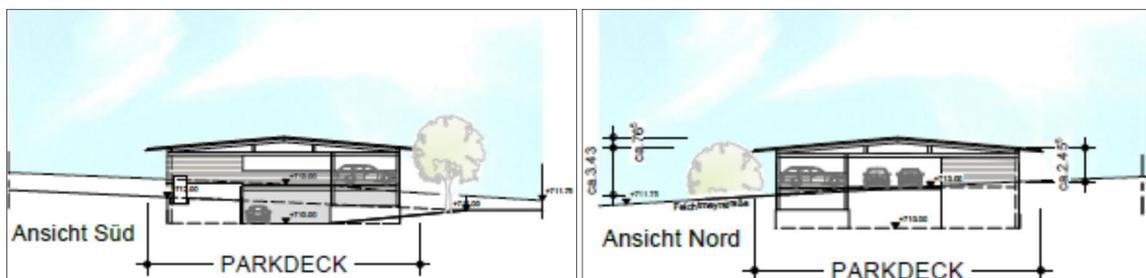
Ansichts- und Schnittdarstellung geplantes zweigeschossiges Parkdeck
